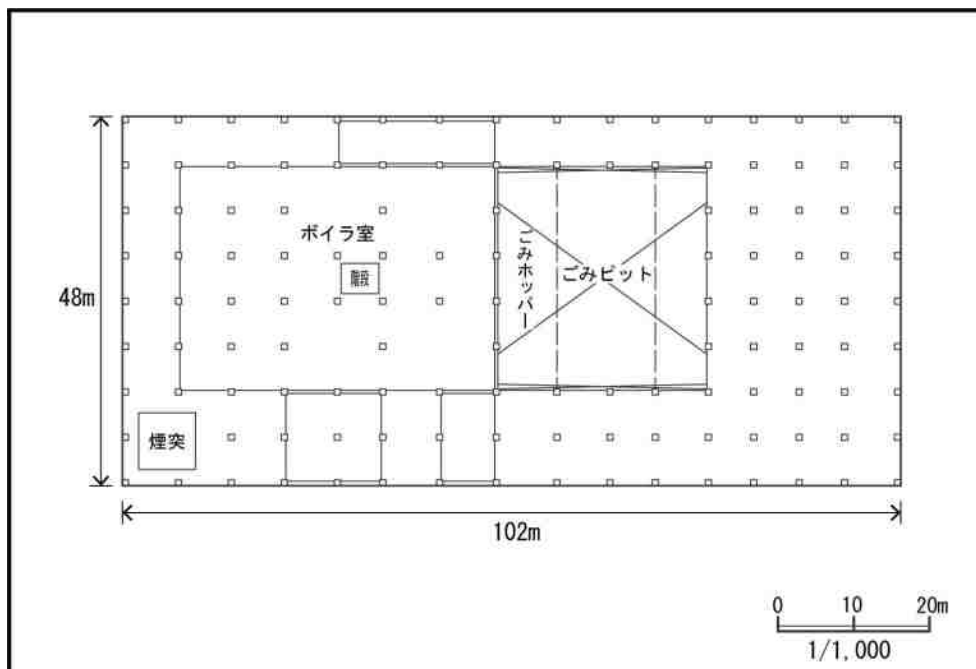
(6) 新施設の平面図（新焼却処理施設 5 階）
